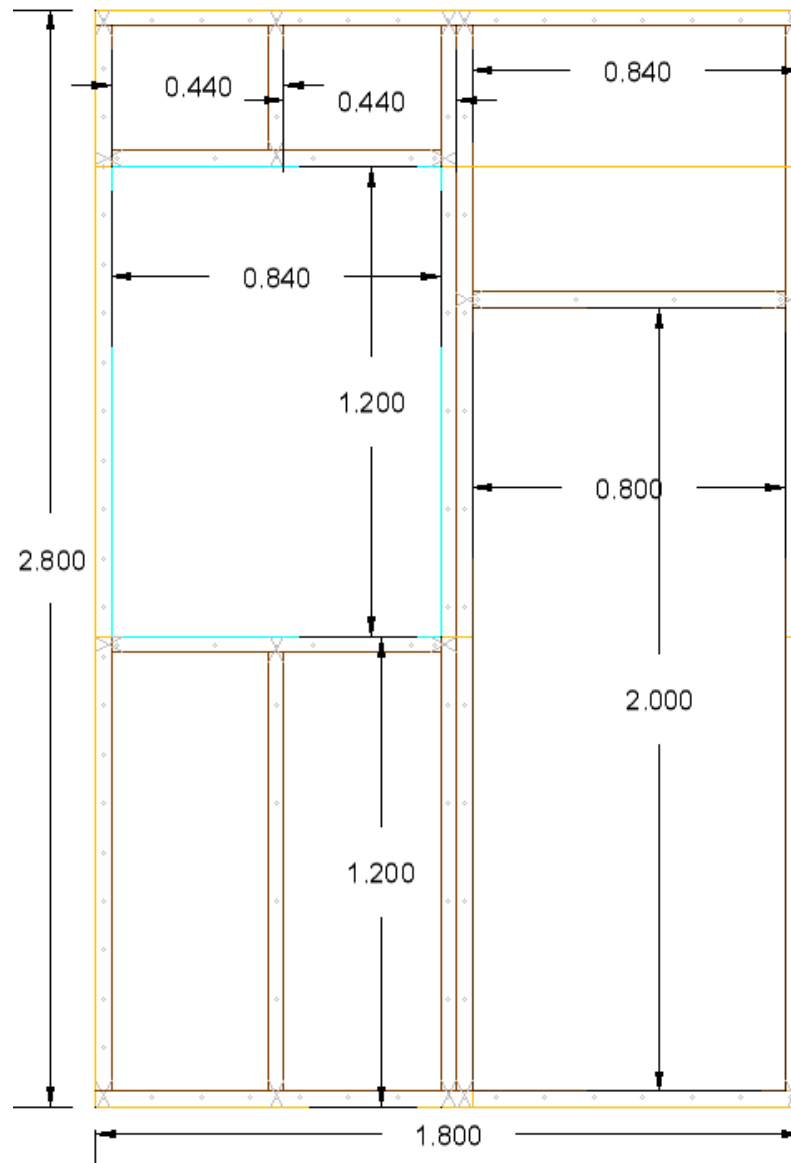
, Muro no estructural M7 1.8 x 2.8
